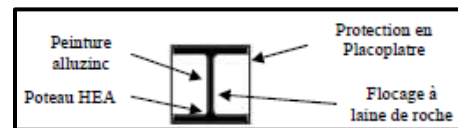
Détail n°02: poteau HEA 300 (1/20) Source : auteur 2019
